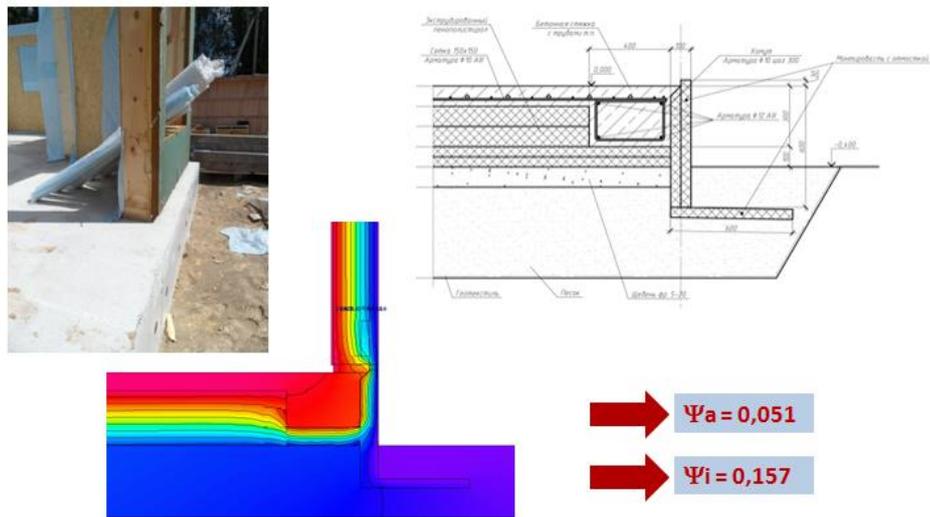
Примыкание наружно стены и фундаментной плиты (УШП).
